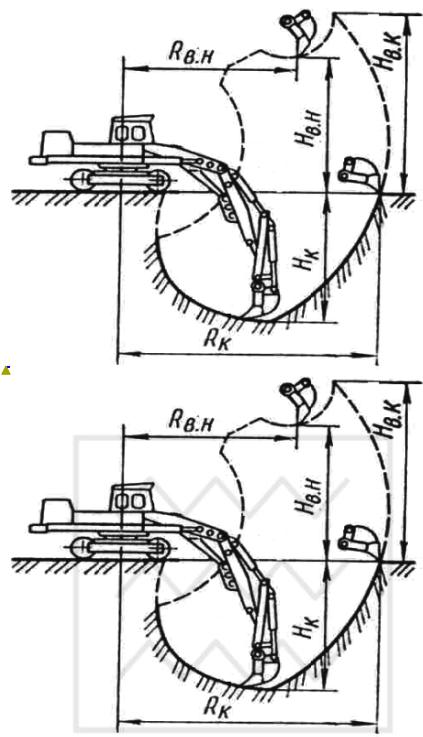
Схеми робочих параметрів одноківшового екскаватора з робочим обладнанням а зворотна лопата:
